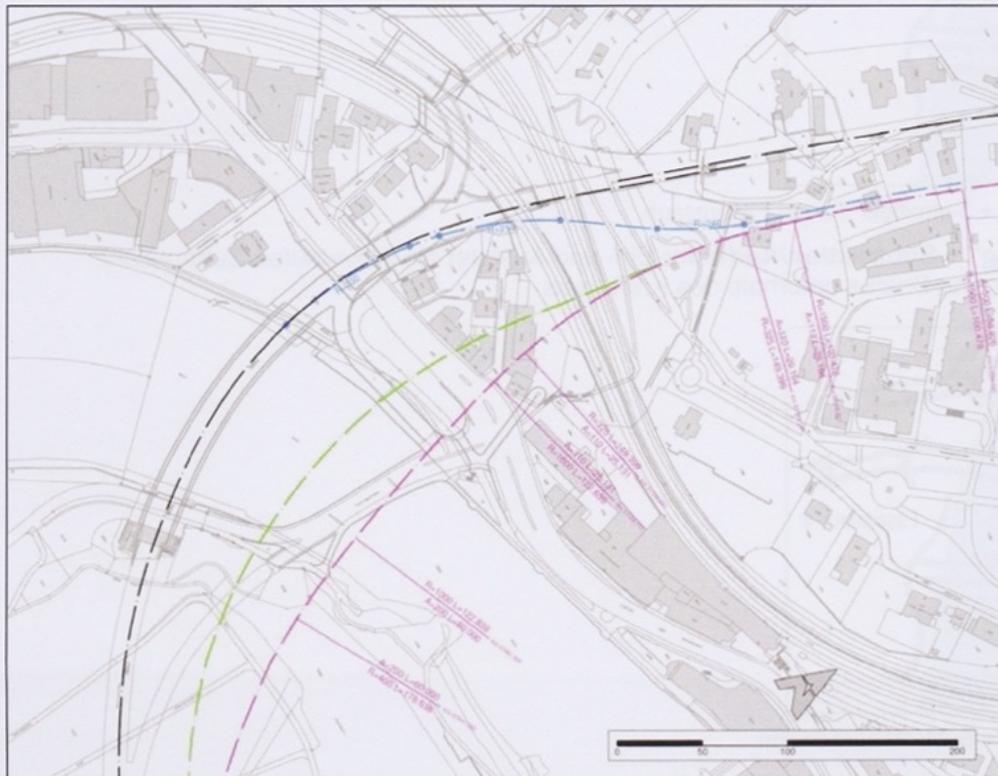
Linienführungsspektrum zwischen der lila und grünen Achse Tunnel Cholfirst II – Tunnel Fäsenstaub II
